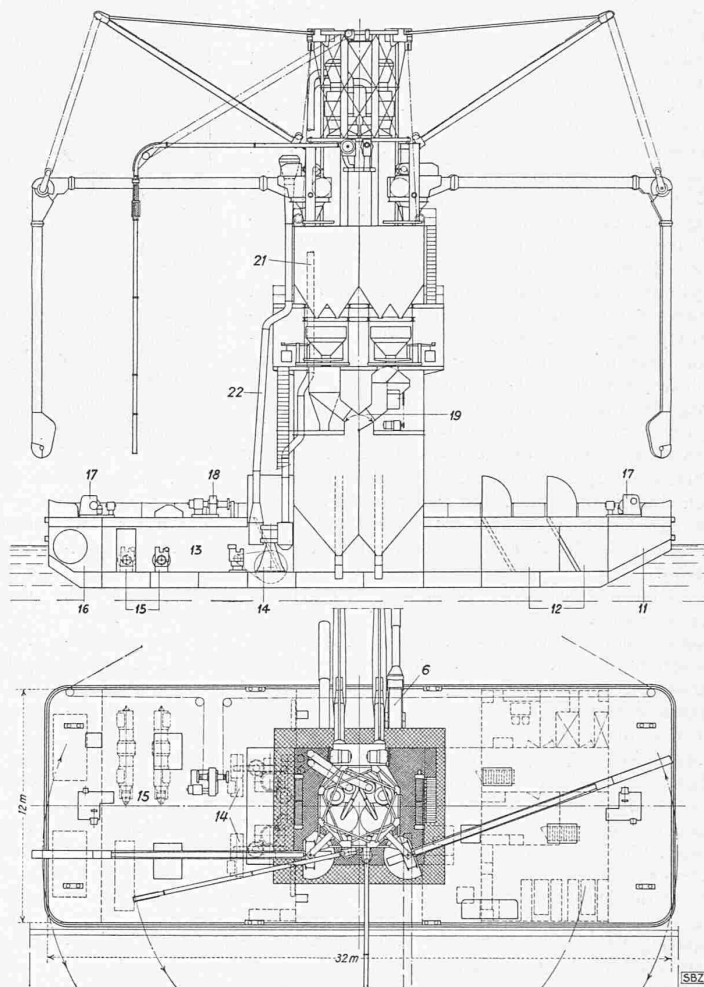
Grundriss und Längsschnitt eines Hebers, 1:350
